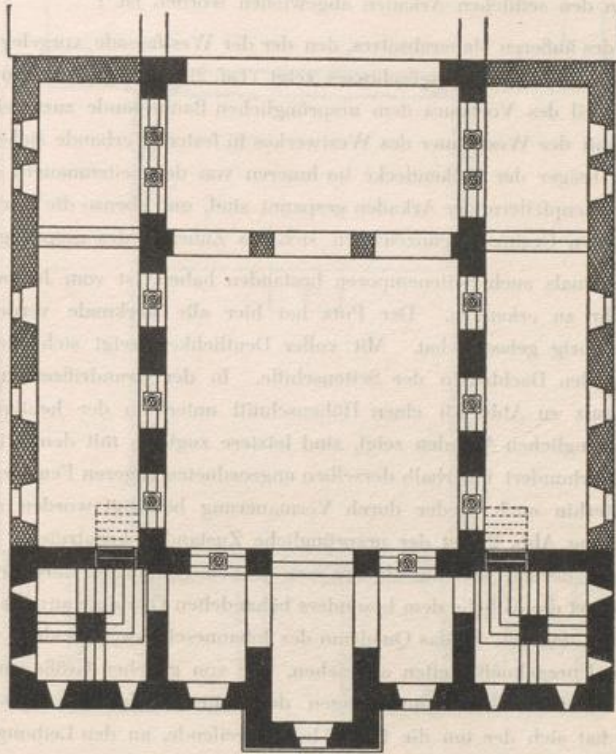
Grundriß-Rekonstruktion des ursprünglichen Emporengeschoßes (885)
